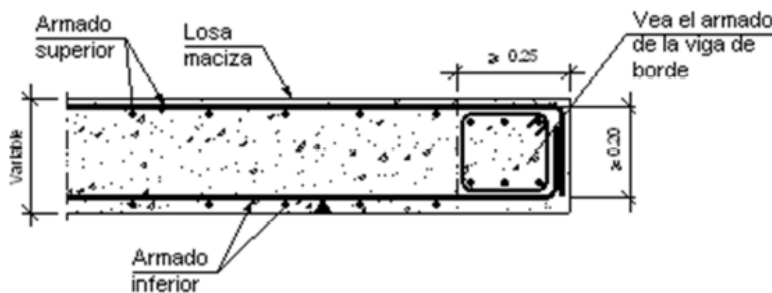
Detalle de losa de entrepiso. Fuente El autor. (2015)
